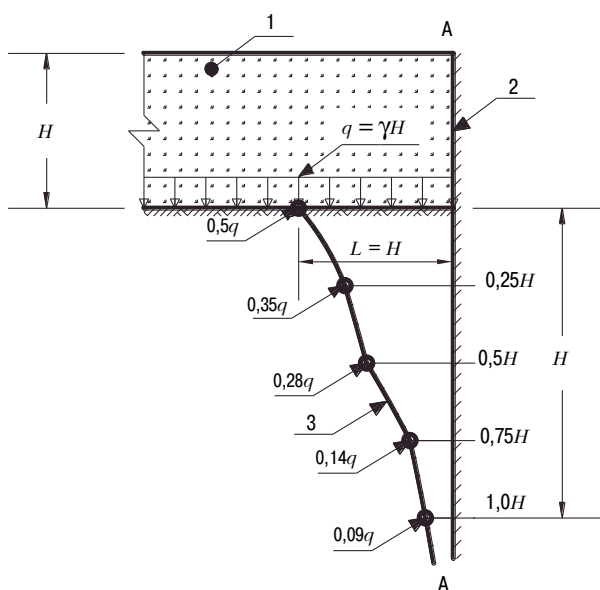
Эпюра горизонтального давления грунта основания на заднюю грань А-А свайного фундамента устоя:
